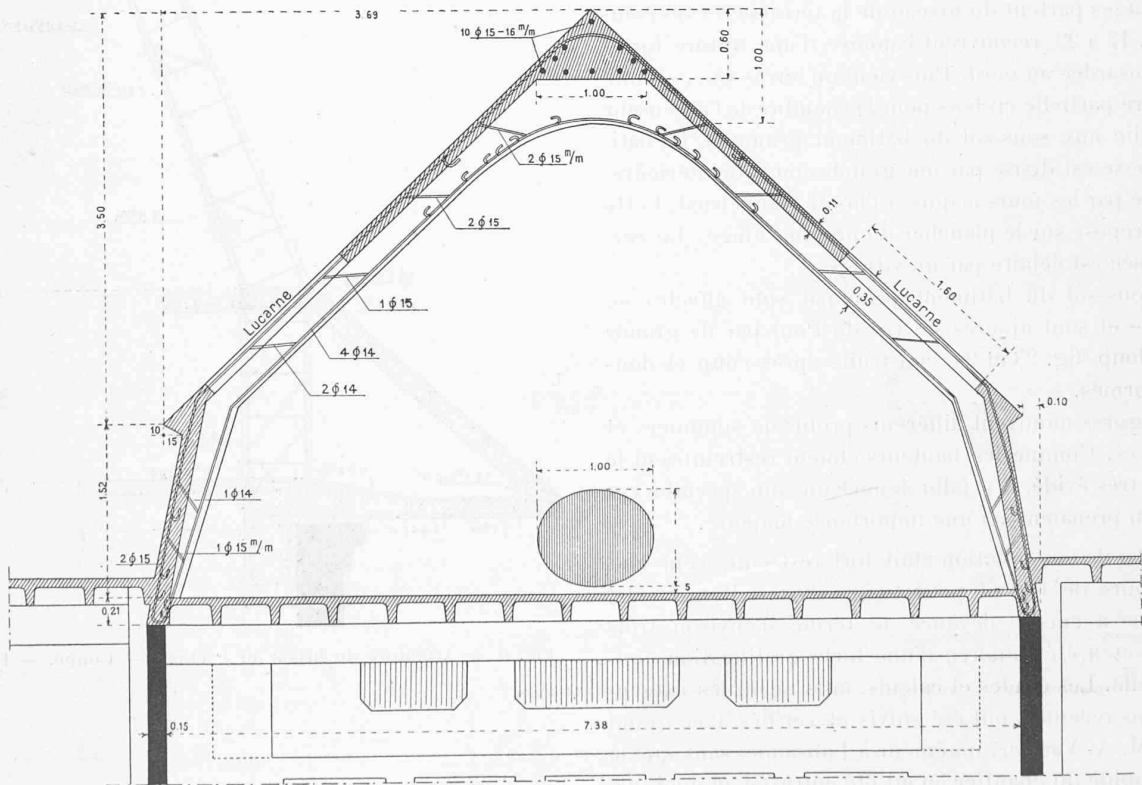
Coupe sur avant-corps. — 1 : 60.
